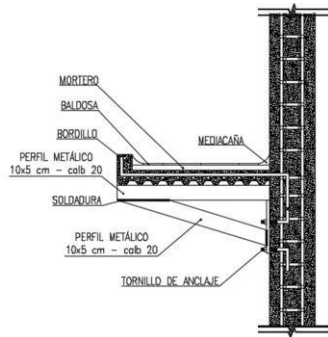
Detalle Pie de Amigo, Instituto de aprendizaje técnico de Leyva
